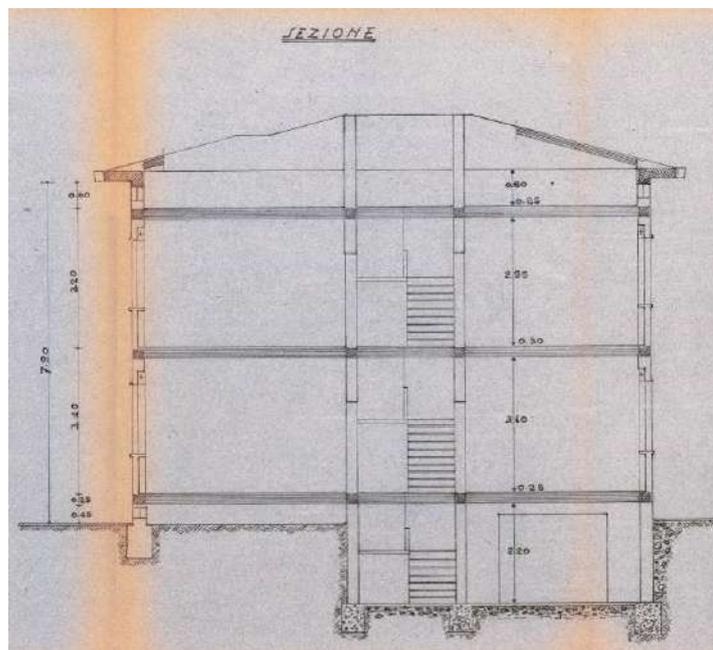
Licenza di Costruzione n. 1289 del 04.03.1968 – sezione
